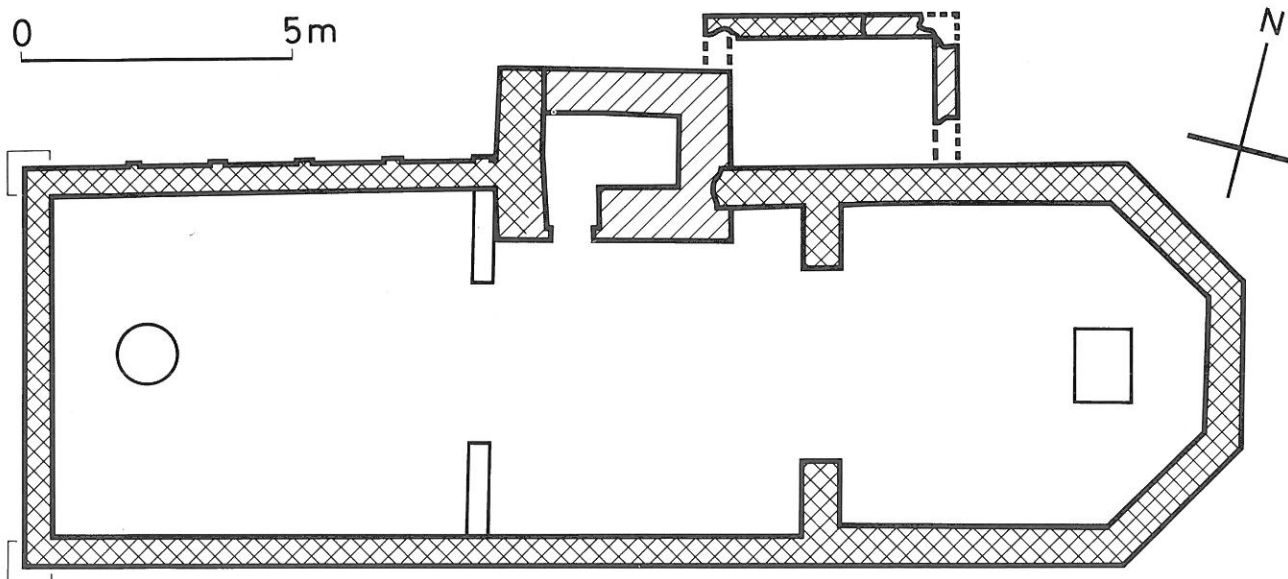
Grundriss der Anlage VI. M. 1:140
